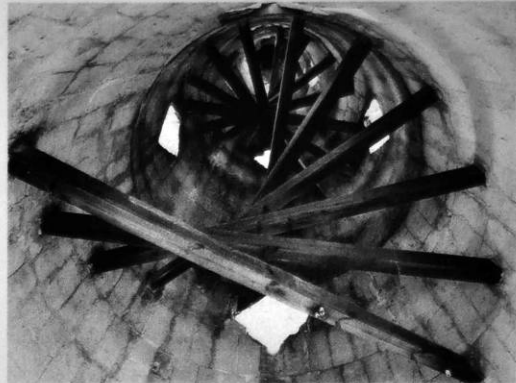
Travesaños de madera para absorber los empujes del viento. (Foto Jordi Isern, febrero de 1990).
